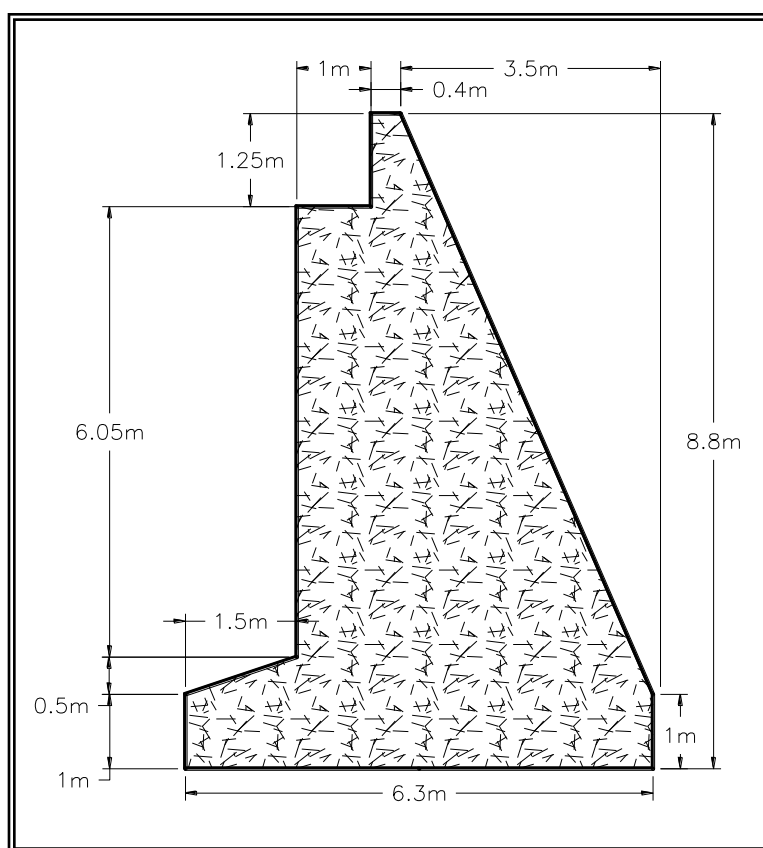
Geometría del estribo de mampostería de piedra, sin escala.
